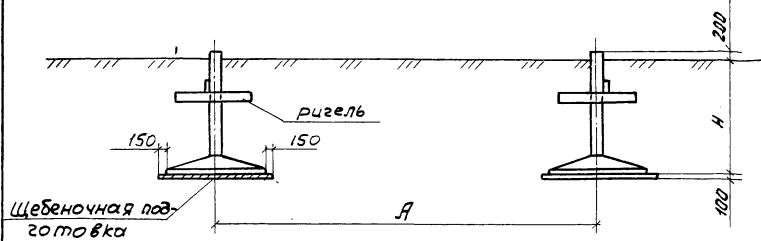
Схема фундаментов под промежуточно-угловую опору ПЧБ-20
